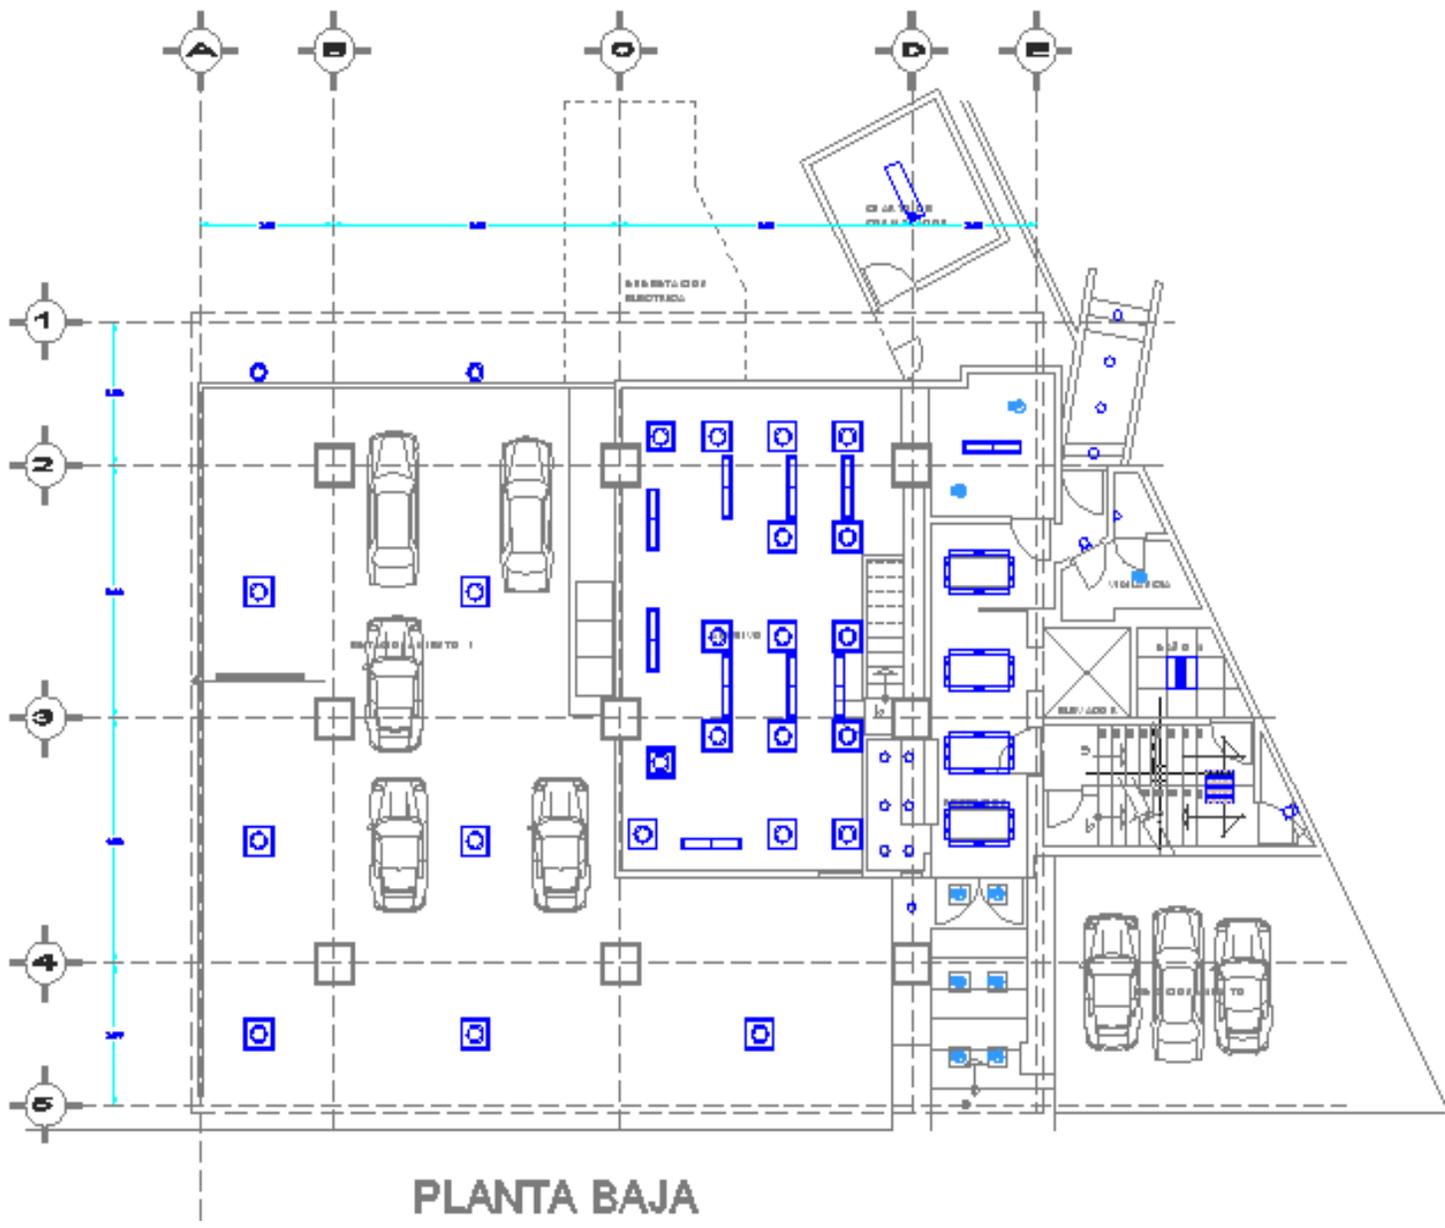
Ubicación simbólica de la carga de alumbrado en planta baja.
